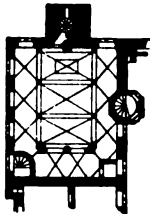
Schlosskapelle in Stuttgart. Erdgehoß mit eingetragener Empore.
